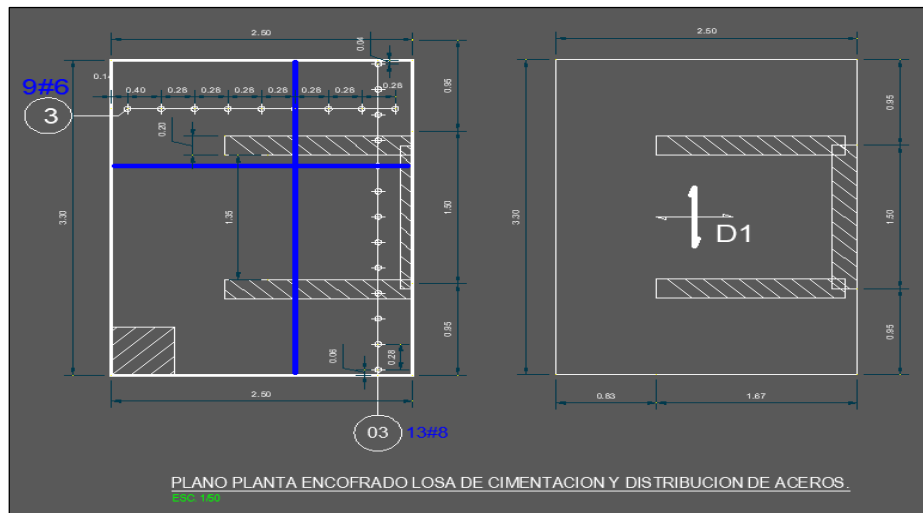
Plano planta detallado de la losa de cimentación -ascensor.
